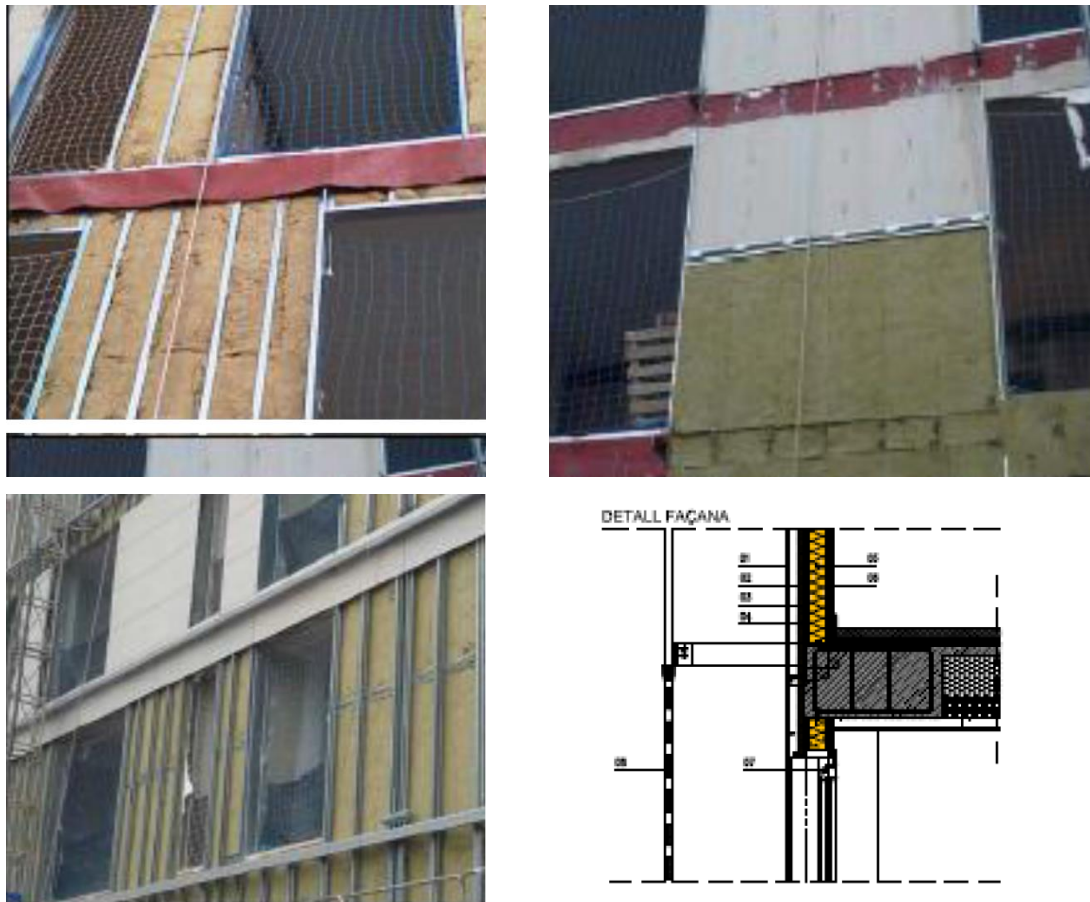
Aplicación de la fachada ventilada en la obra, aislamiento térmico, soporte y perfiles verticales.
